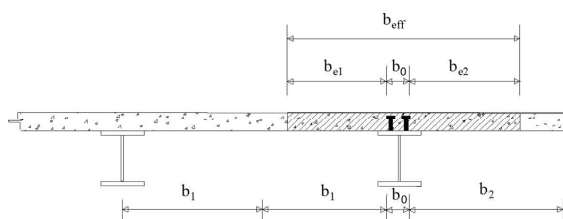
Definizione della larghezza efficace b_{eff} e delle aliquote b_{ei}
